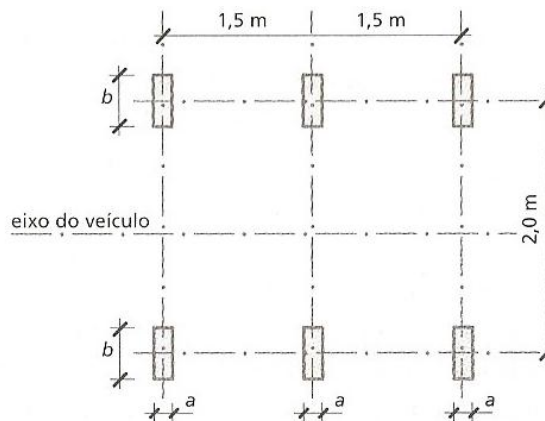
Veículo tipo segundo o RSA, em planta (RSA, 2010).
